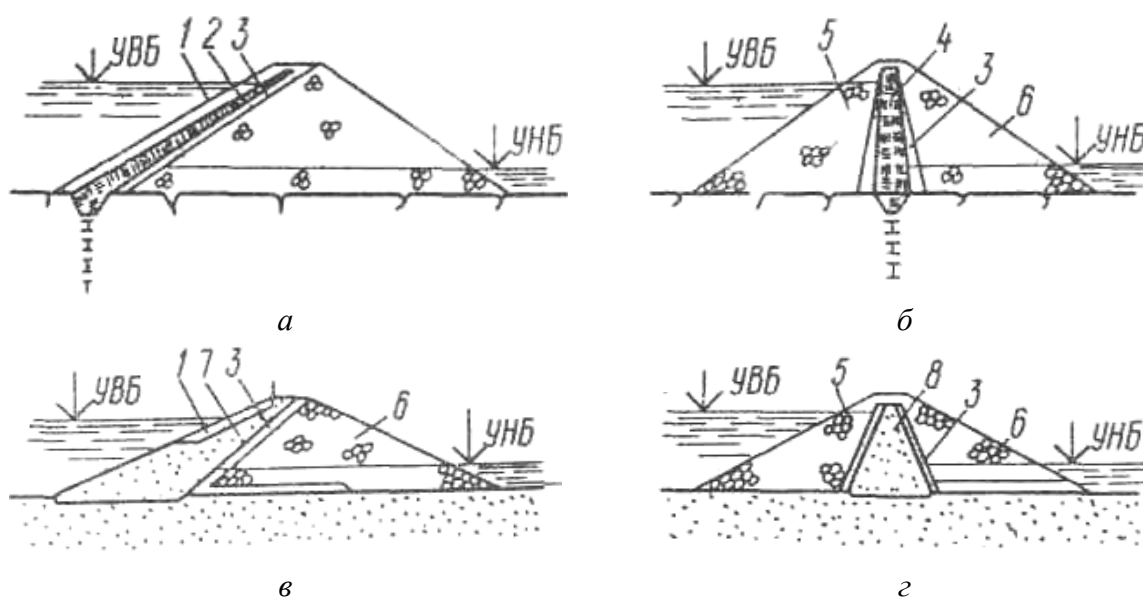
Виды каменно-земляных плотин: а – с грунтовым экраном; б – с грунтовым ядром; в – с верховой грунтовой призмой; г – с центральной грунтовой призмой; 1 – крепление верхового откоса; 2 – грунтовый экран; 3 – переходные слои (обратные фильтры); 4 – грунтовое ядро; 5, 6 – верховая и низовая призма; 7, 8 – верховая и центральная грунтовые противοфилтрационные призмы
